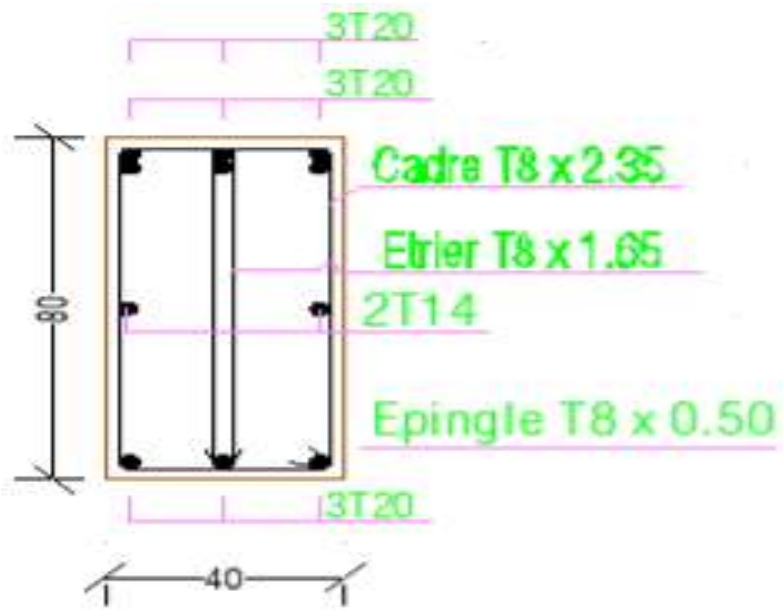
Disposition constructive des armatures des poutres sur appui
